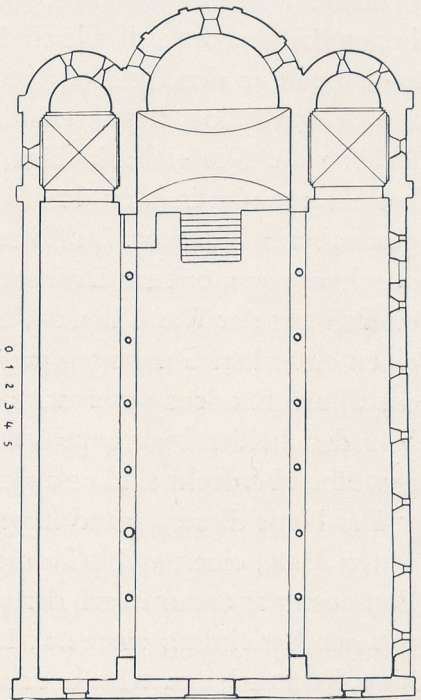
Agliate, S. Pietro. Grundriß (nach Kingsley-Porter)
